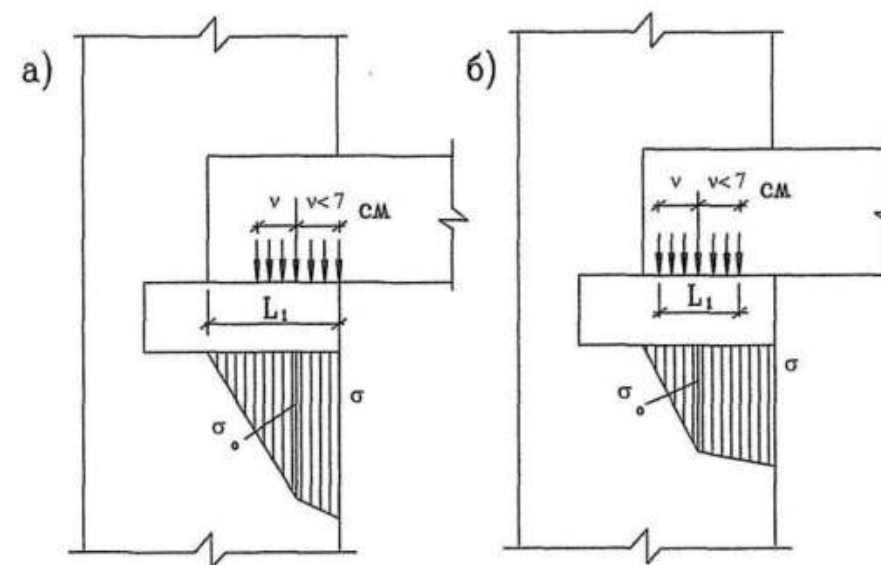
Схема нагрузок и напряжения при расчете опорной плиты
